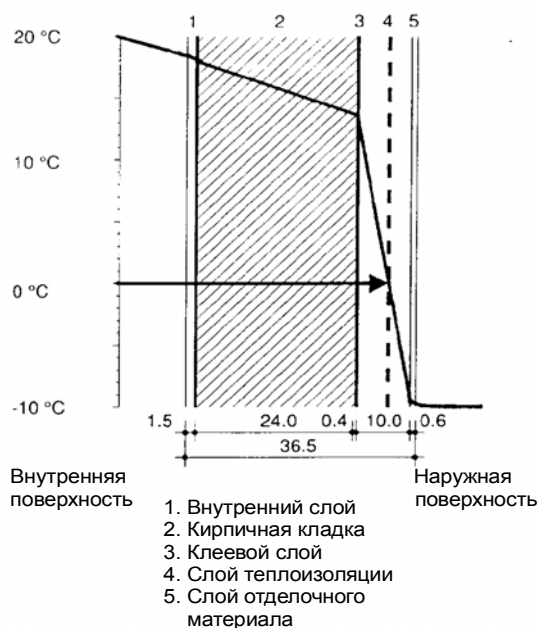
Конструкция стены с наружным теплоизоляционным слоем
